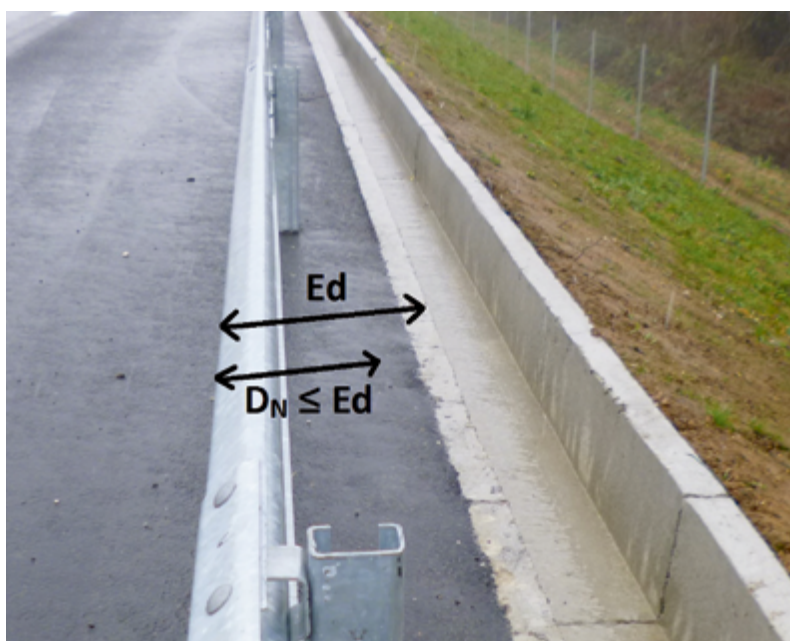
Isolement d'un caniveau non couvert constituant un obstacle selon l'espace disponible  $E_d$  (Source : Cerema)
